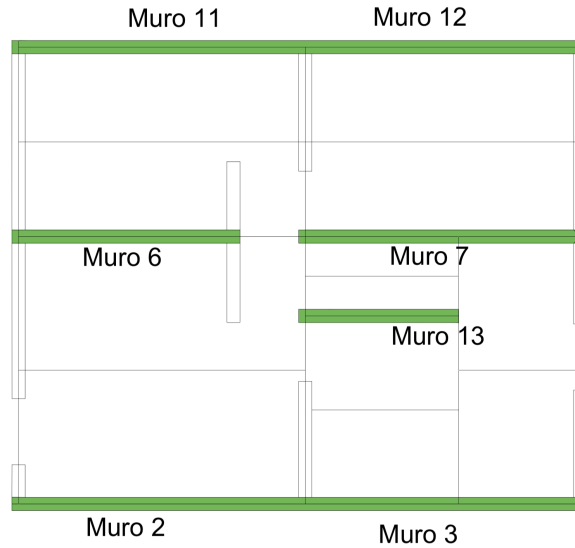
Muros del primer nivel que soportarán las cargas de la losa de entrepiso.
